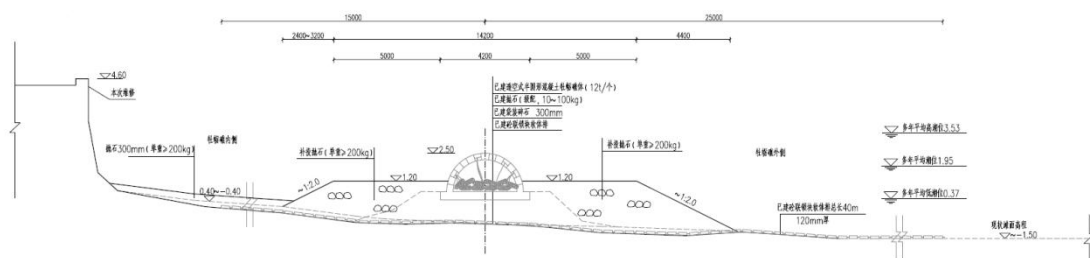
已建牡蛎礁加固断面图 (港灣凹地)
